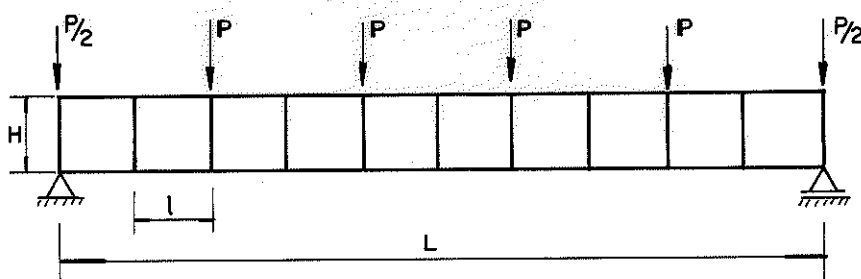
Viga Simplesmente Apoiada, Submetida a Carregamento Externo.
